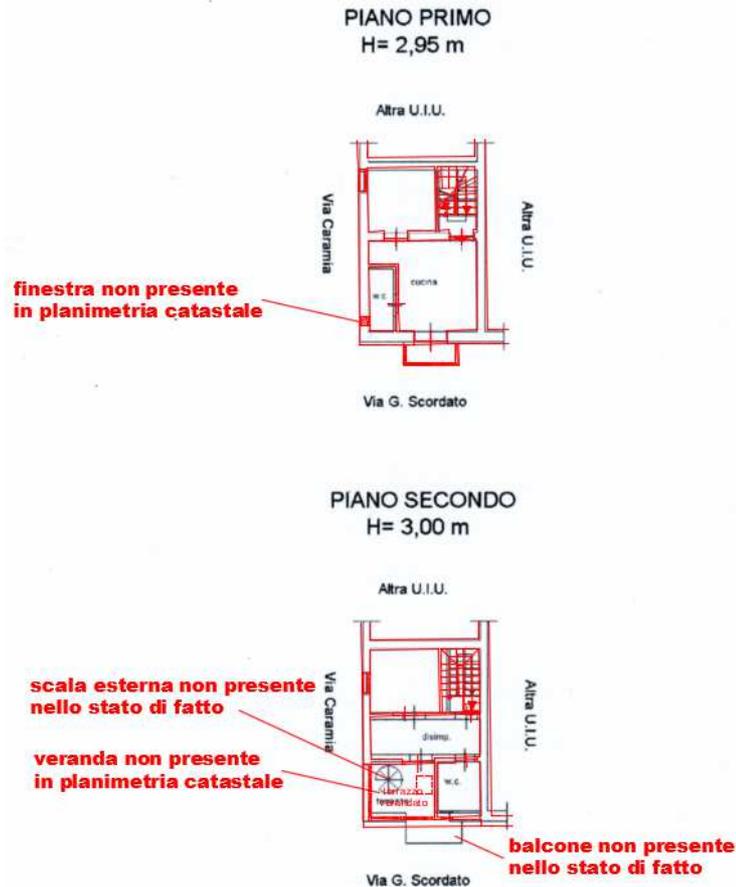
Sovrapposizione delle planimetrie di rilievo con la planimetria catastale
